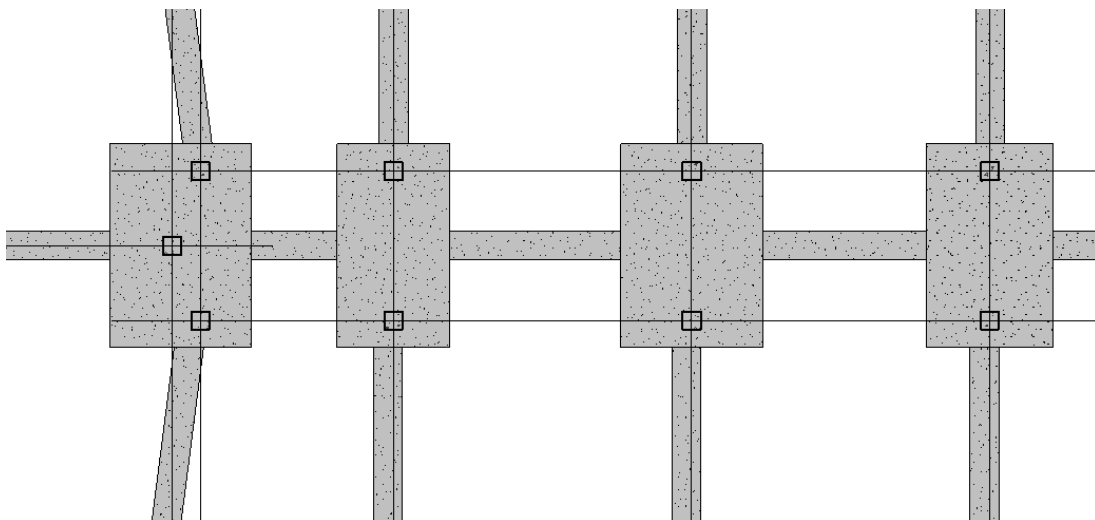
Vista en planta de la versión de las zapatas del proyecto real
